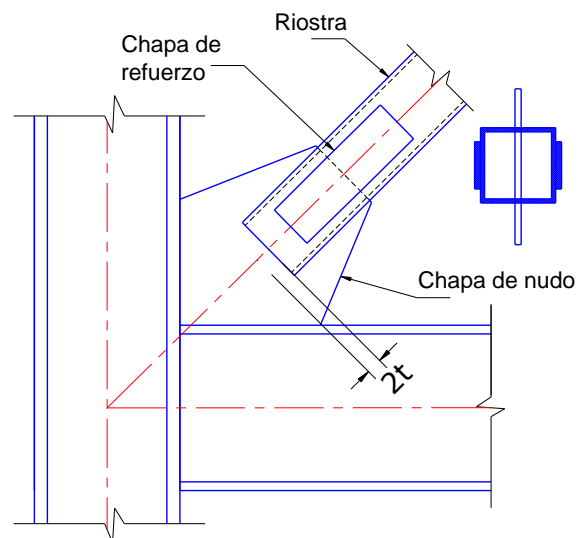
Detalles para conexión de riostras de sección tubular reforzada con chapas adicionales.
